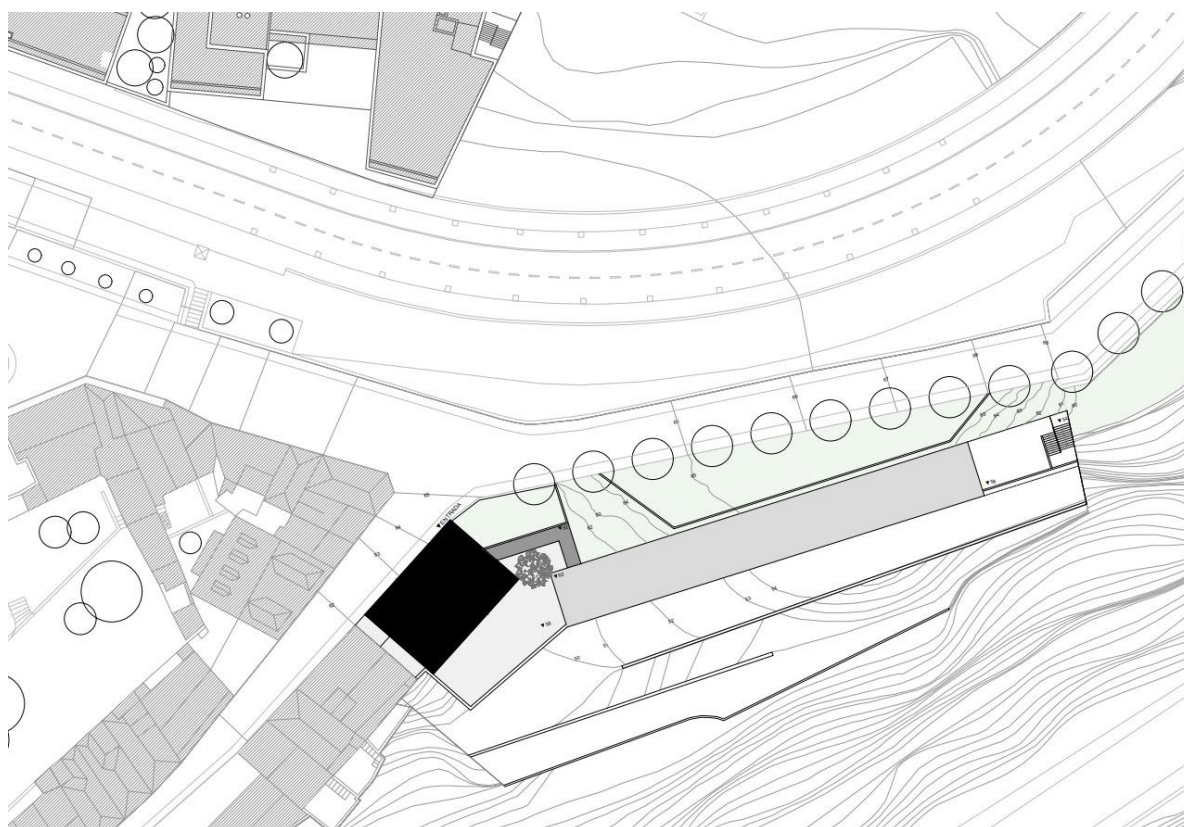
Planta de Implantação do Projeto V com a divisão programática (Fonte: Autor)
